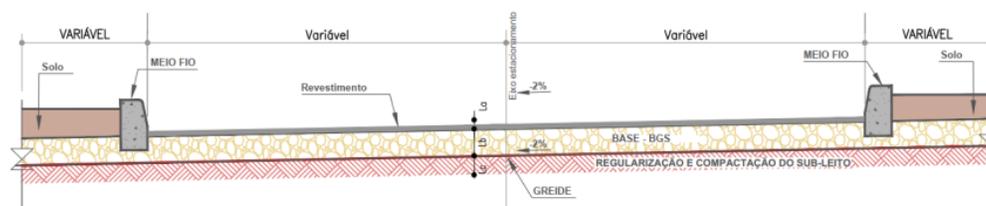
Seção Tipo - Pavimento Flexível - Projeto de Pavimentação
